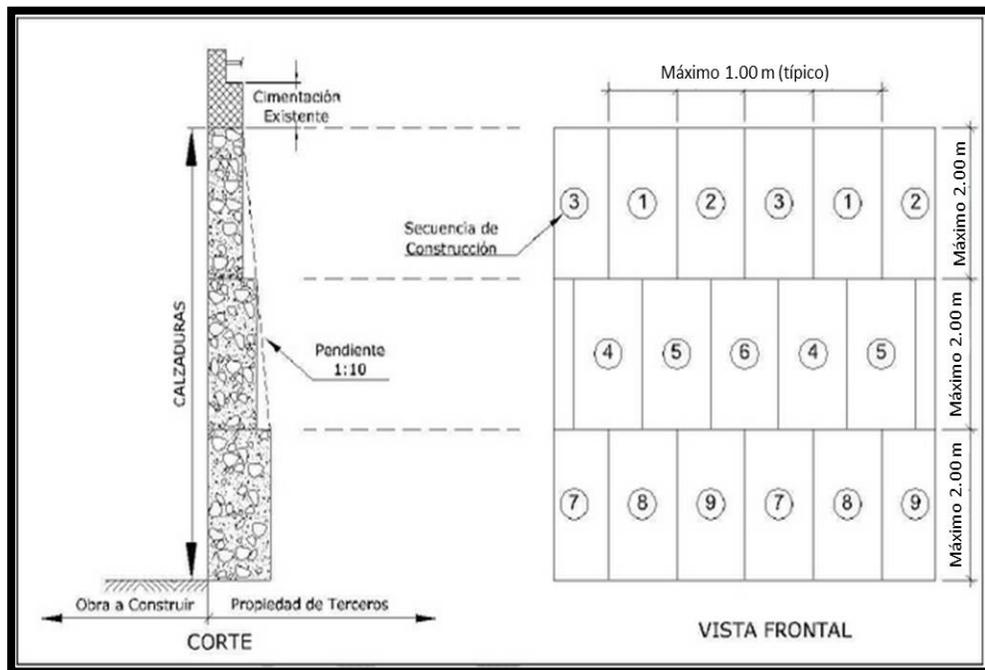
a Elevación típica de calzadura; los números indican la secuencia de construcción de los paños de la calzadura. (N.T.E. E.050, 2009, editada)
